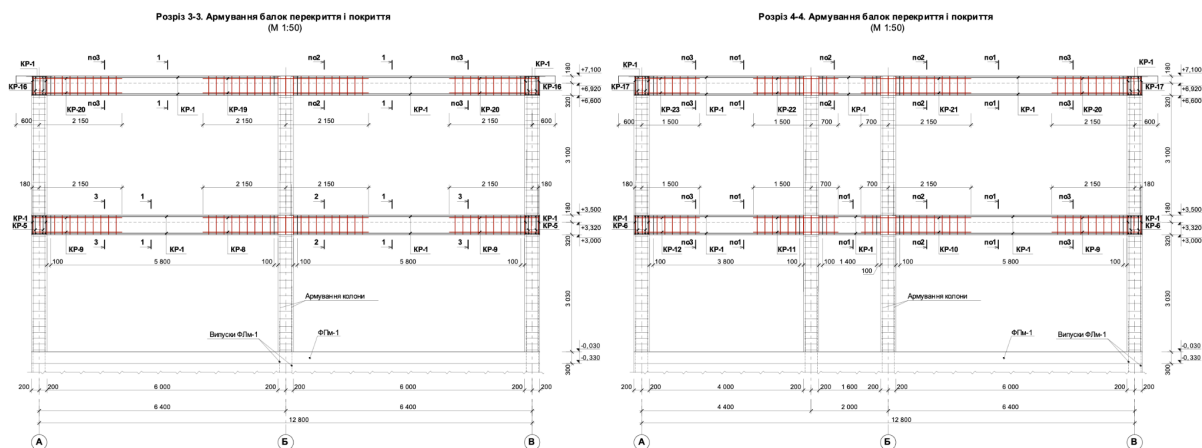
Армування балок перекриття і покриття (розрізи 3-3 та 4-4)
